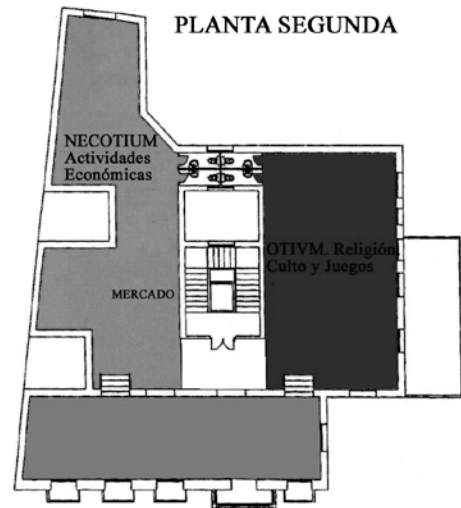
Plano de la planta segunda del Museo de la Romanización.
